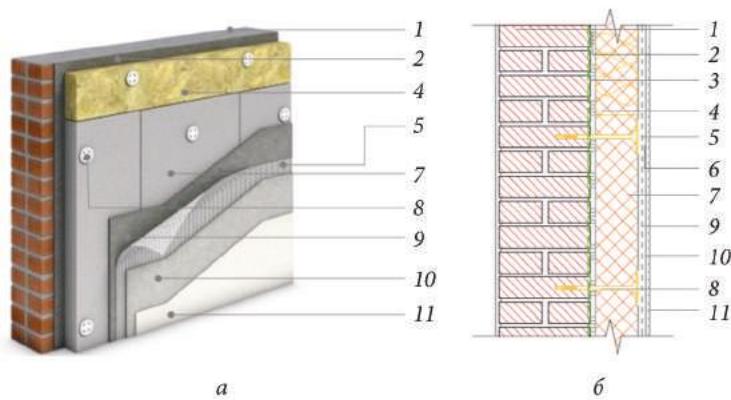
Система ТН-ФАСАД Комби: *а* — общий вид; *б* — схема; 1 — несущая стена; 2 — клей для теплоизоляционных плит; 3 — упрочняющая грунтовка; 4 — противопожарные рассечки из минеральной ваты TECHNOFAC, TECHNOFAC L; 5 — стеклотканевая сетка; 6 — декоративная штукатурка; 7 — утеплитель — плиты из экструзионного пенополистирола TECHNONIKOL CARBON ECO FAS; 8 — тарельчатый фасадный анкер; 9 — базовый армирующий слой; 10 — кварцевая грунтовка; 11 — фасадная краска (по необходимости)
